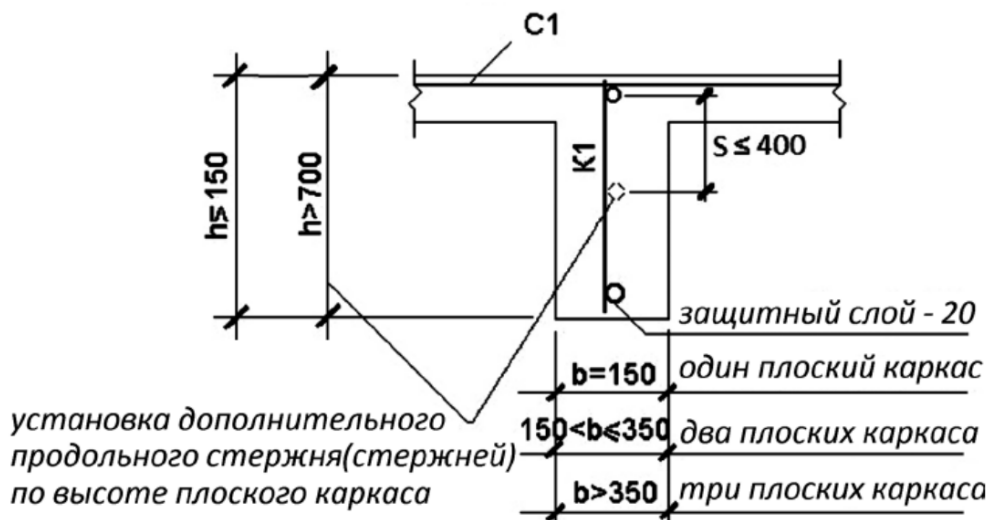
Конструктивные требования к армированию балок монолитных конструкций
